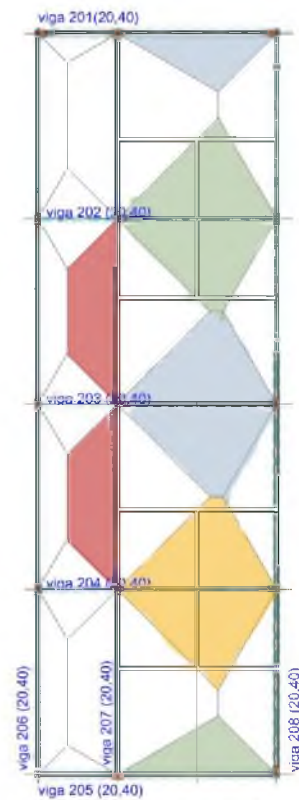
Áreas de influência das vigas do primeiro pavimento
